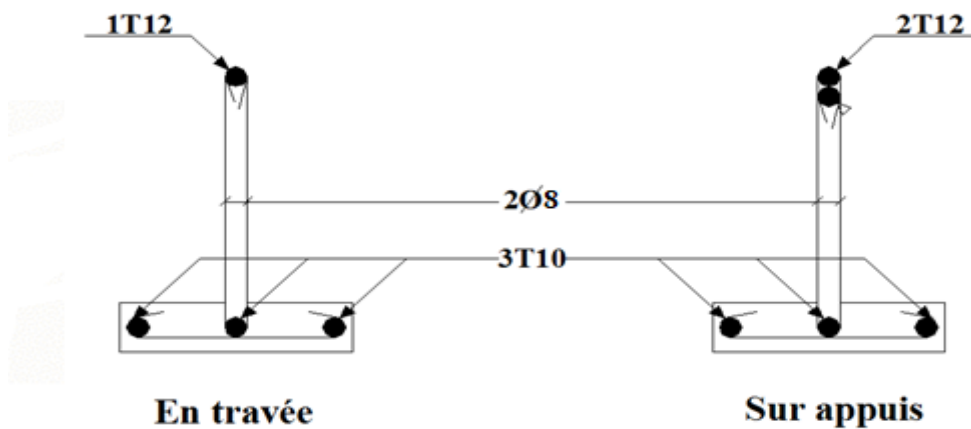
Schéma de ferrailage des poutrelles plancher 1^{er}.
